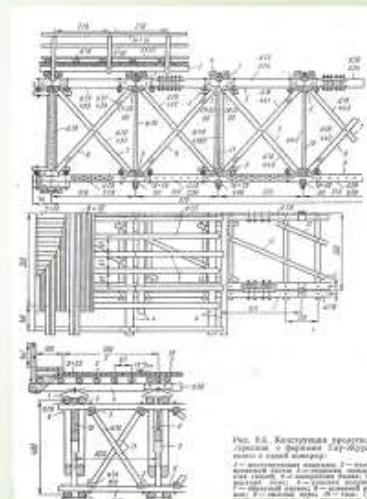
Конструкция простого стропила с фермой (ар-оборудована с галер-оборудована)
